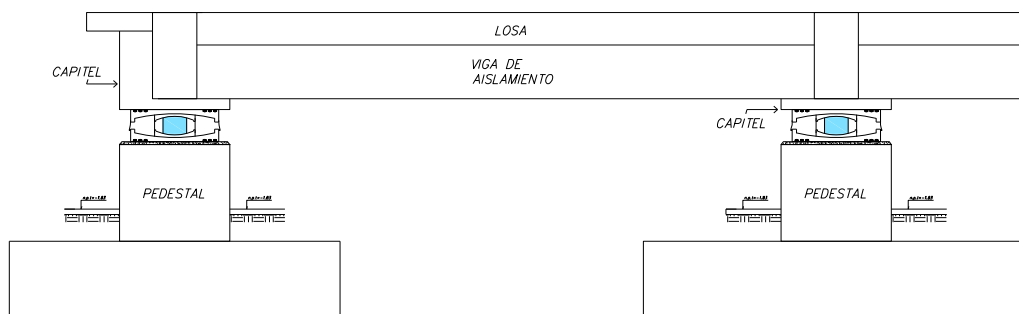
Sistema de aislamiento y subestructura. (Fuente Propia).
